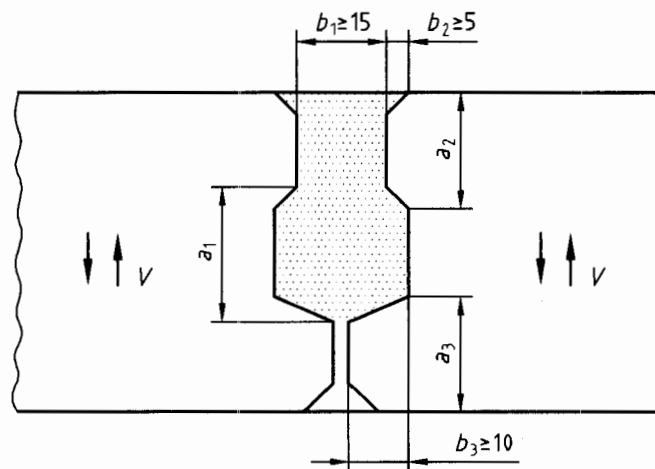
Beispiel für eine Fuge mit doppelter Nut
